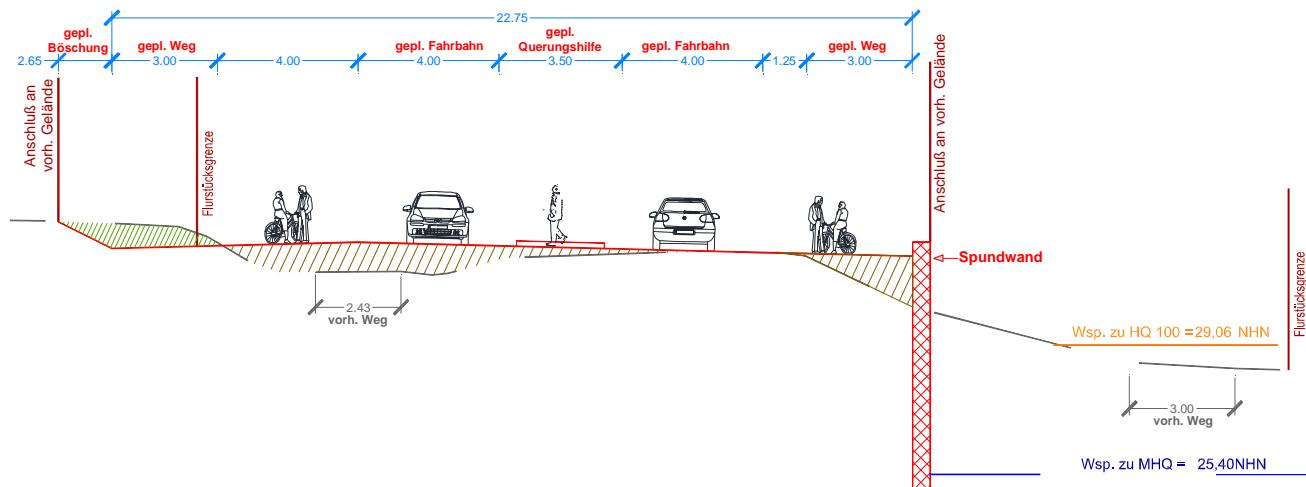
Abschnitt 1, Vorzugsvariante Trasse T1
